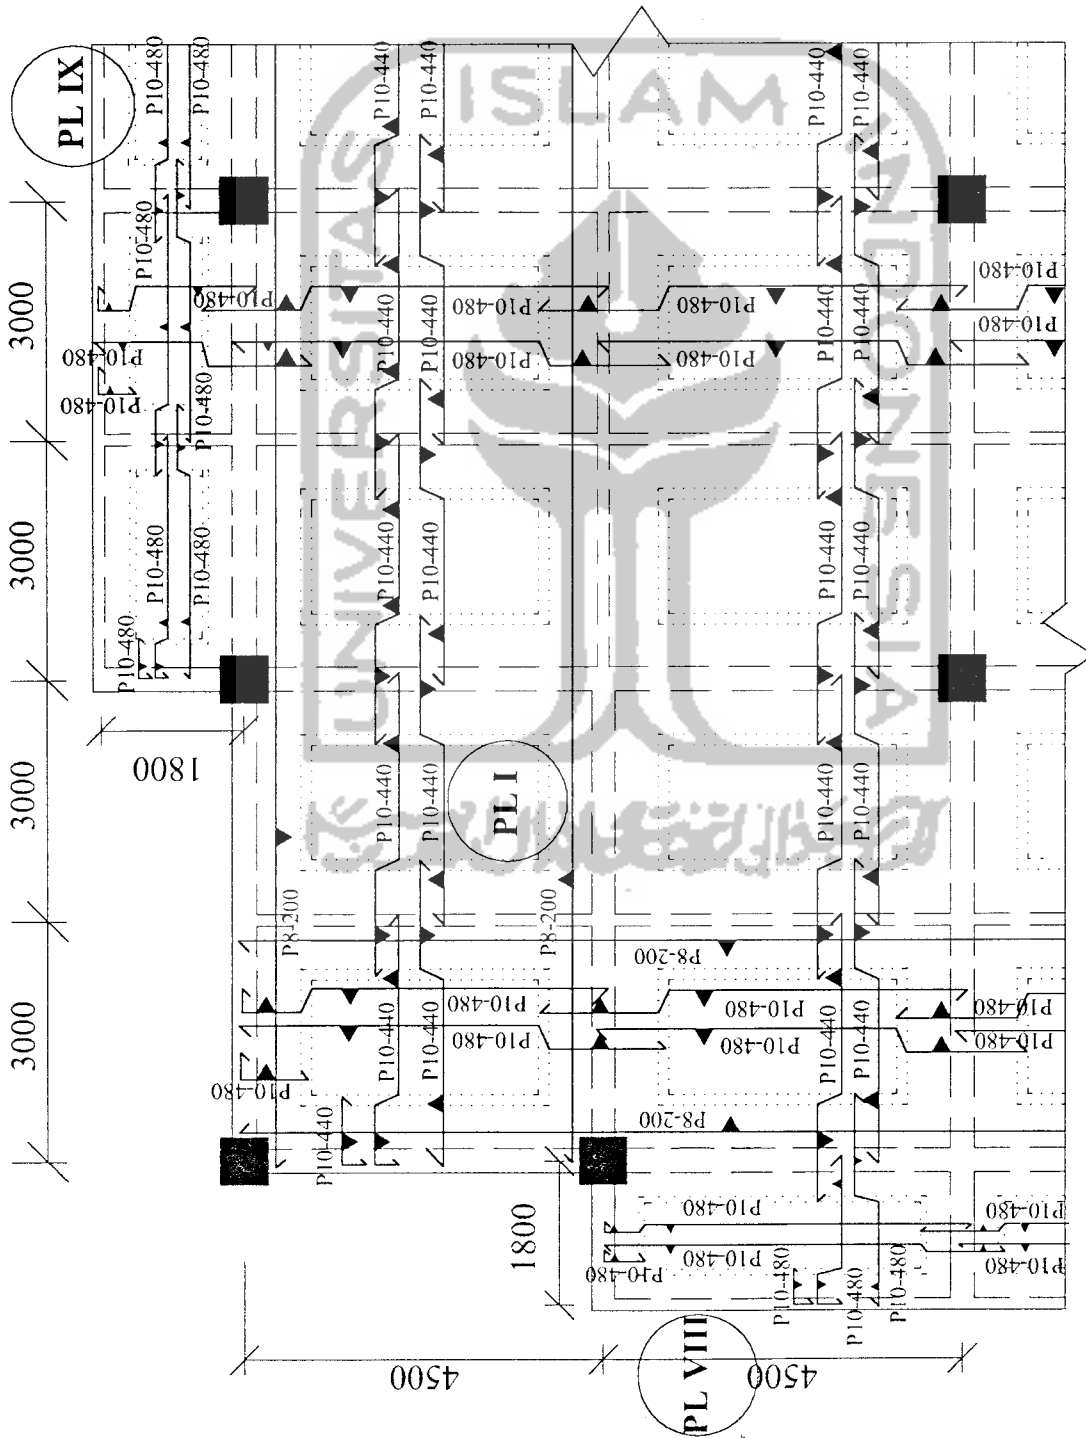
DETAIL PENULANGAN PLAT TIPE I, II & III LANTAI 3
